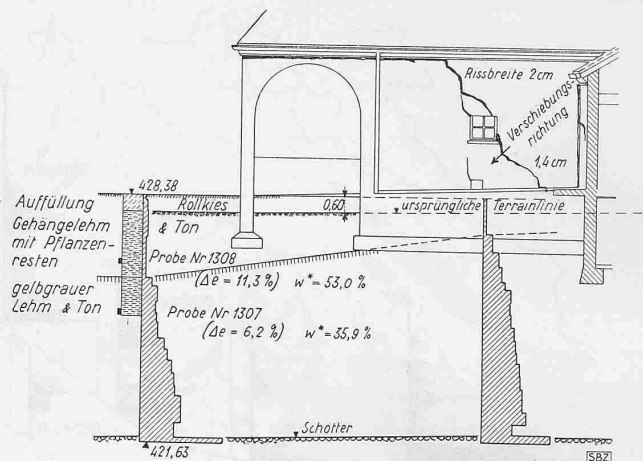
Baugrunduntersuchung mittels Rammprofilen bei einem durch ungleichmässige Setzungen und Rissbildungen beschädigten Gebäude. Aufnahme durch Ing. Mürger und Dr. Knecht, Geolog
